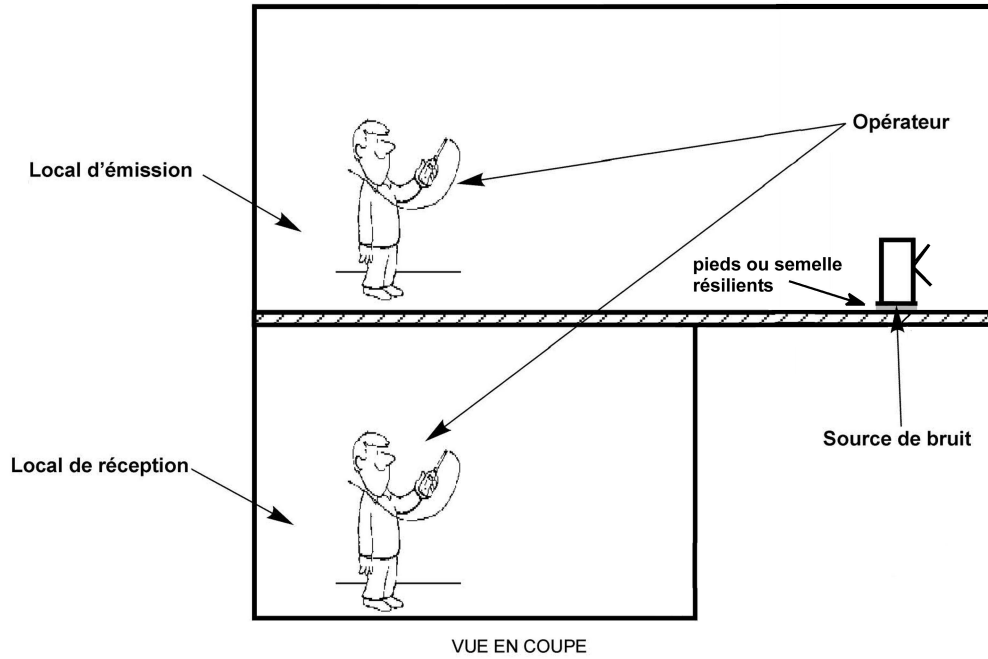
Mesurage de l'isolement vertical entre locaux de dimensions très différentes.
